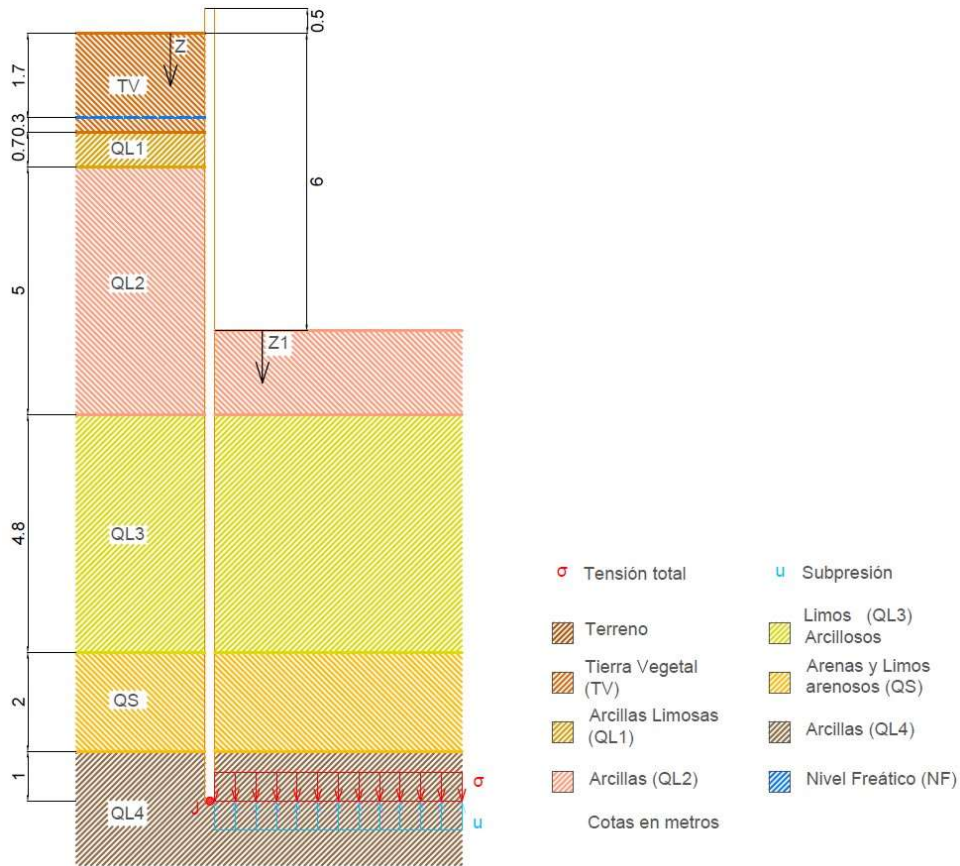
Levantamiento de fondo. Fuente: Elaboración propia.
